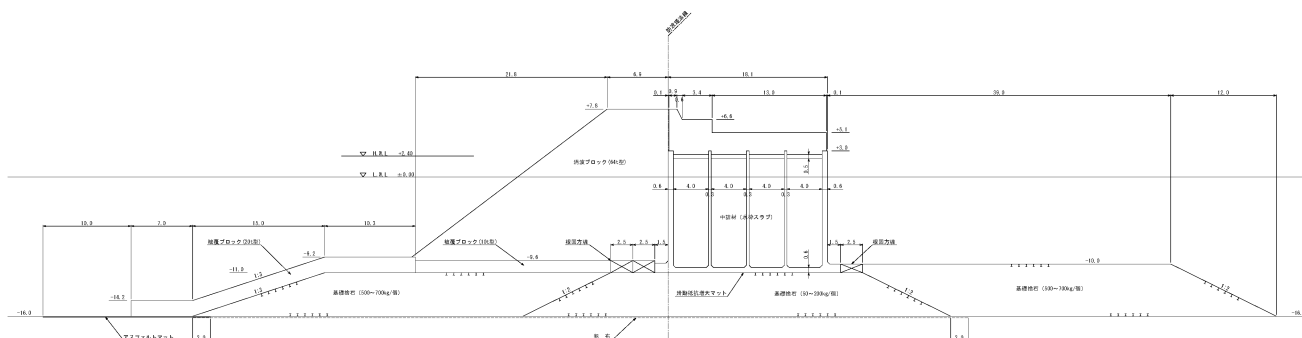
標準断面図 (防波堤 II, 単位 : m)
